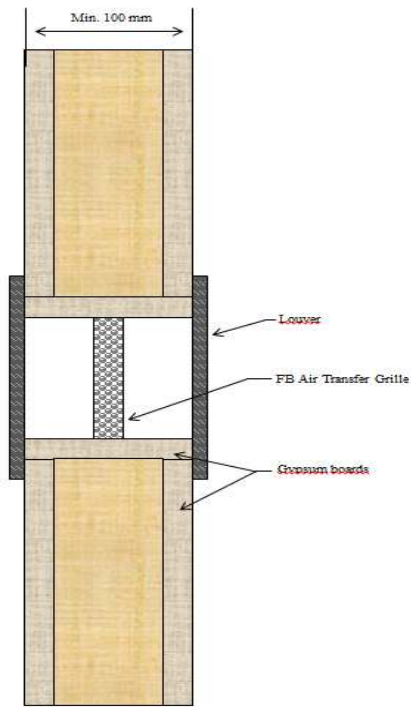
Schéma d'installation de la grille Intramur. Ici, avec des murs en plâtre.
